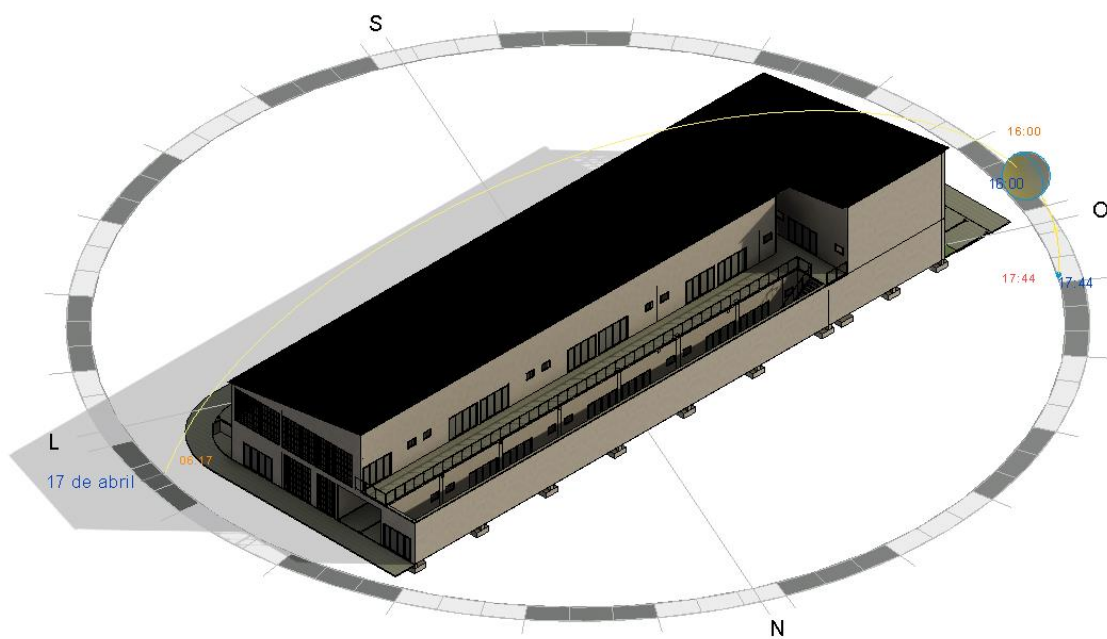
Iluminação solar no outono. Fonte: Projeto de arquitetura proposto.
